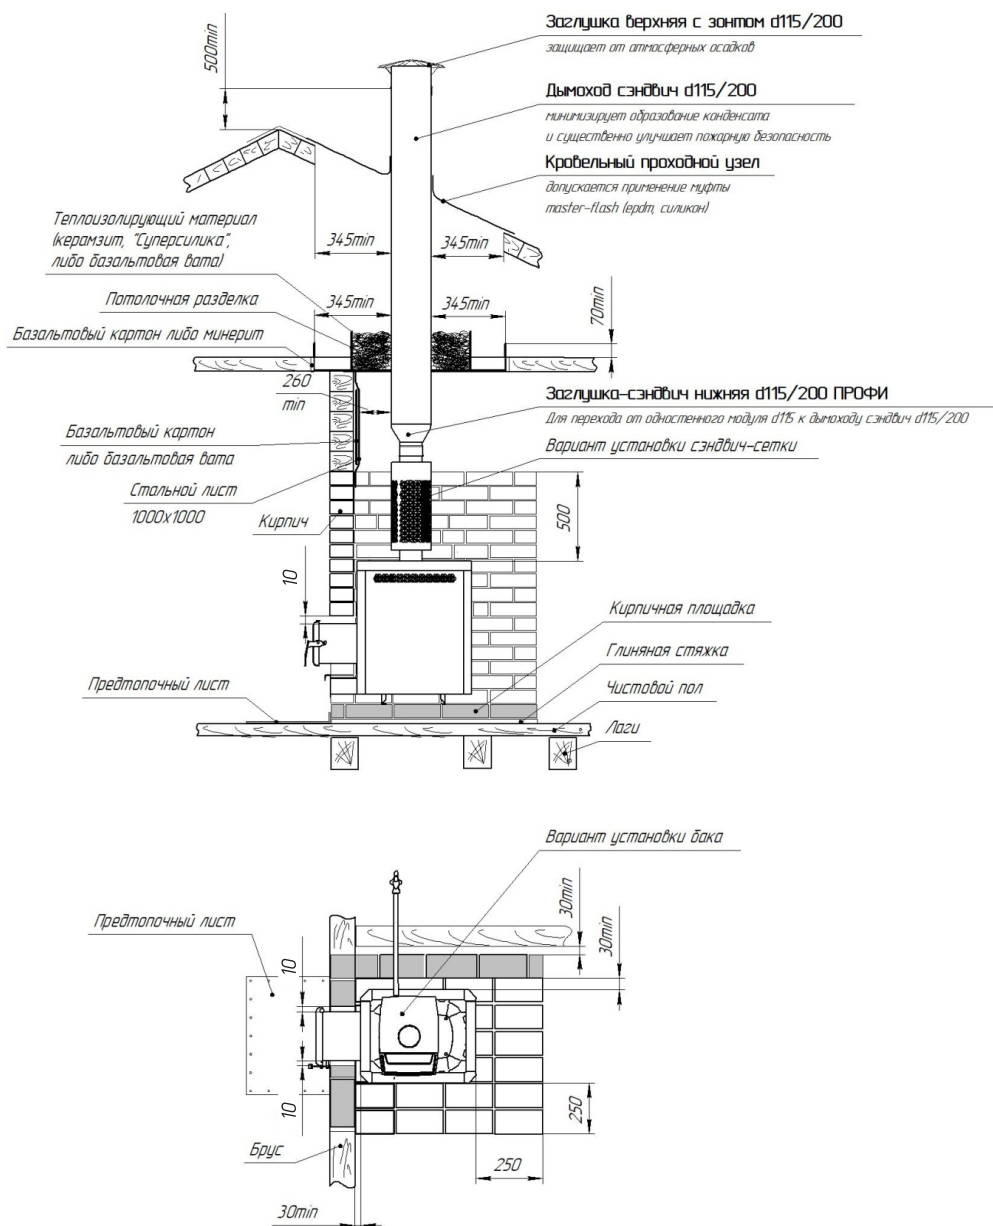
а - Схема установки печи для бани с кирпичной кладкой
